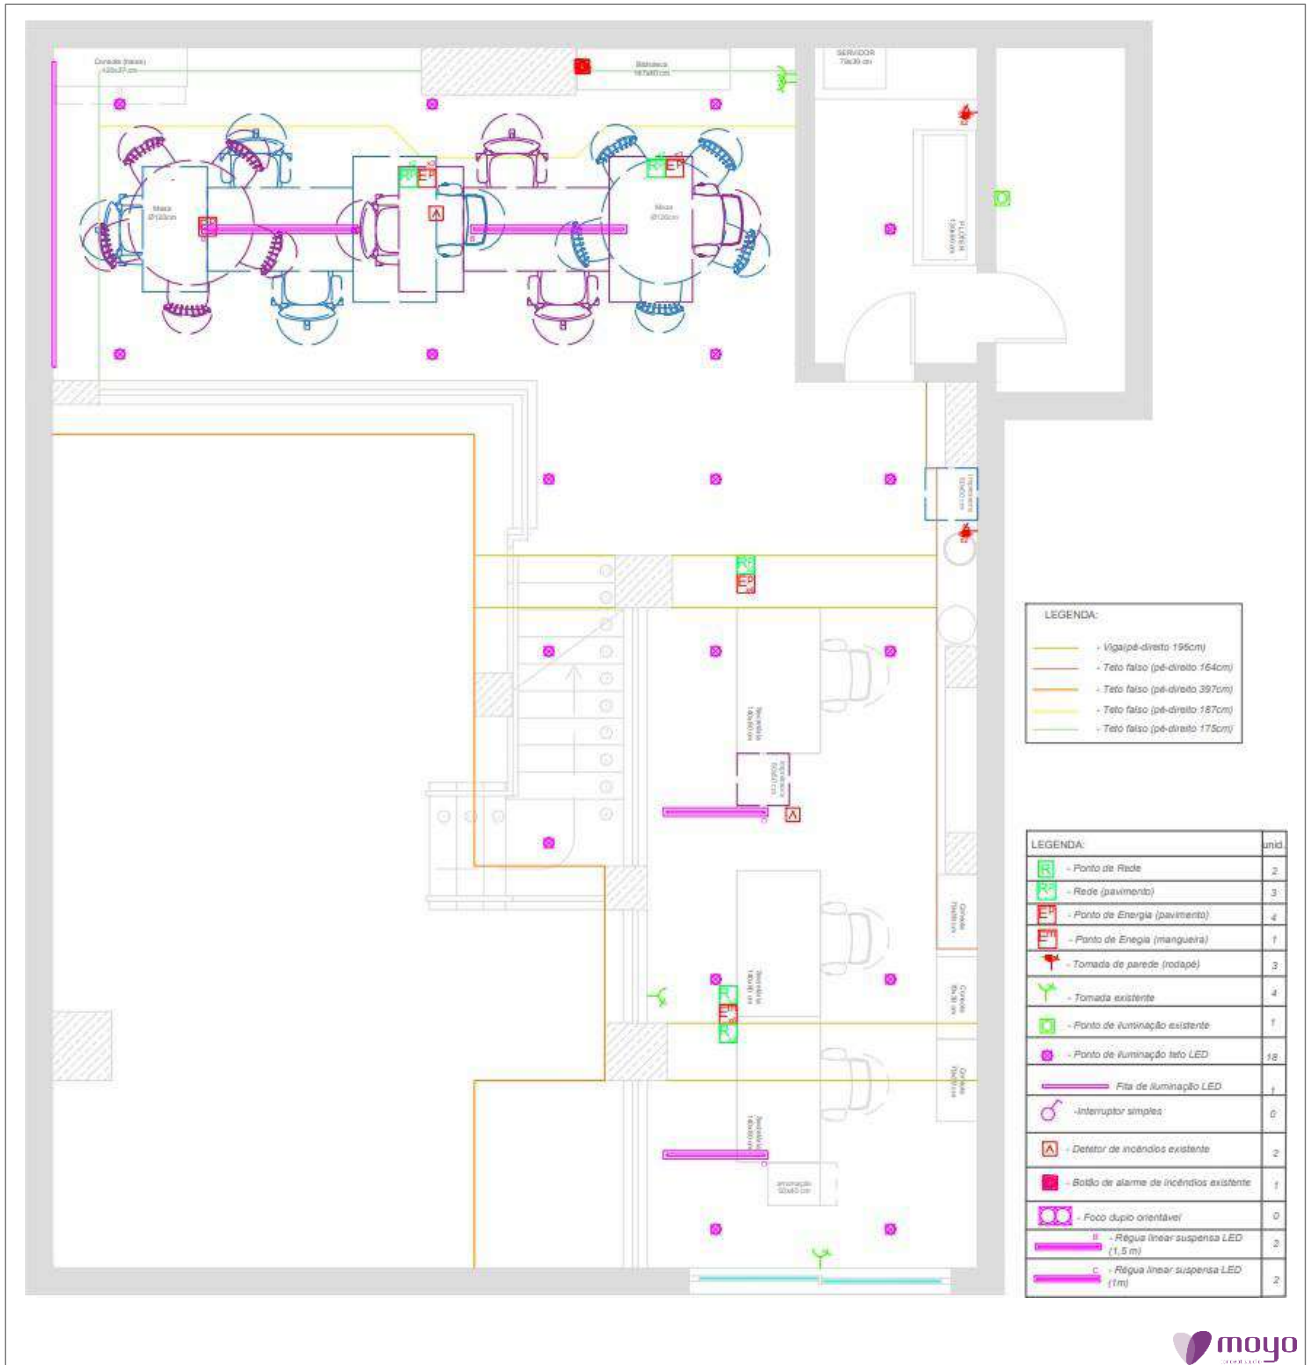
Planta elétrica e de Iluminação Loja Moyo (Piso 1)- OPÇÃO B
